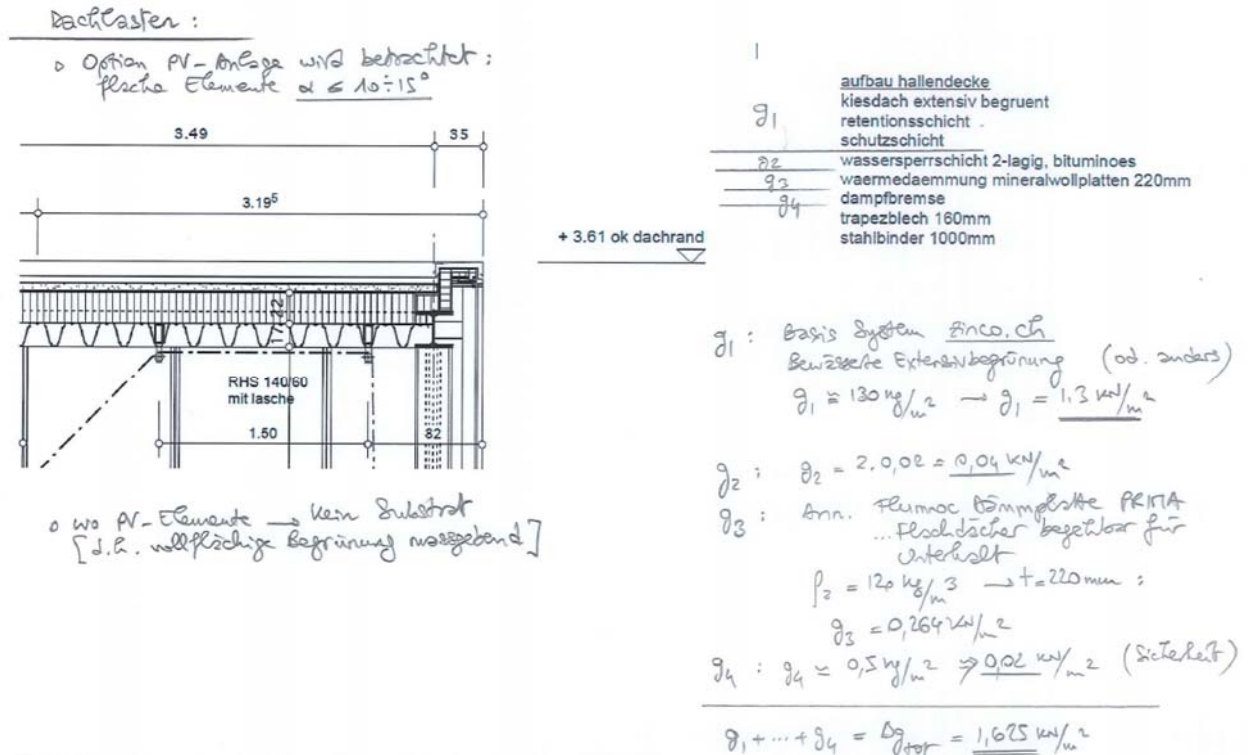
Angenommener Dachaufbau und Auflasten, Stahldach (Referenz: Sporthalle Haulismatt, Balsthal, Tragwerksplanung durch Fürst Laffranchi Bauingenieure GmbH, 2006-08).
